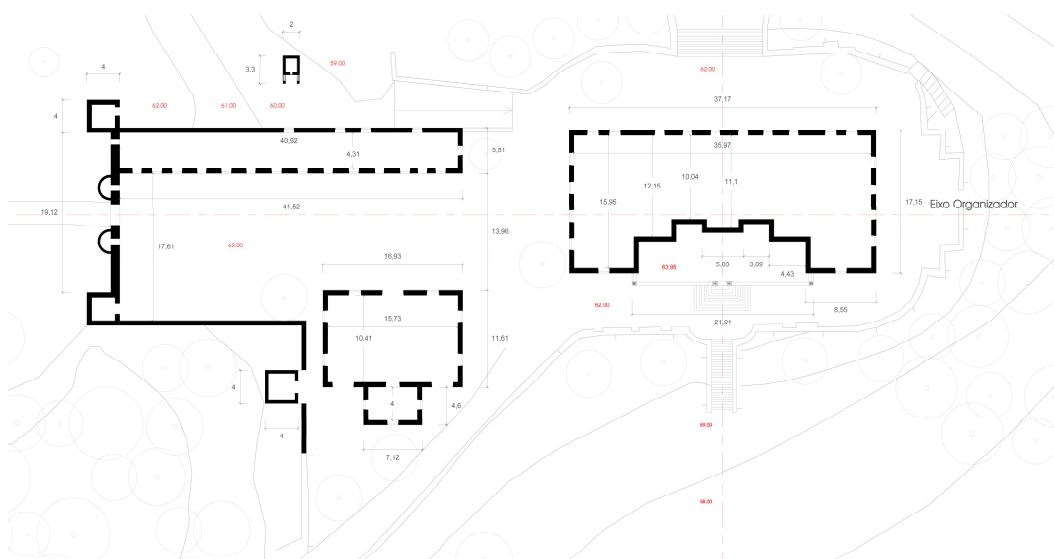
Levantamento arquitectónico da Planta do Piso 1 da Quinta da Conceição.
